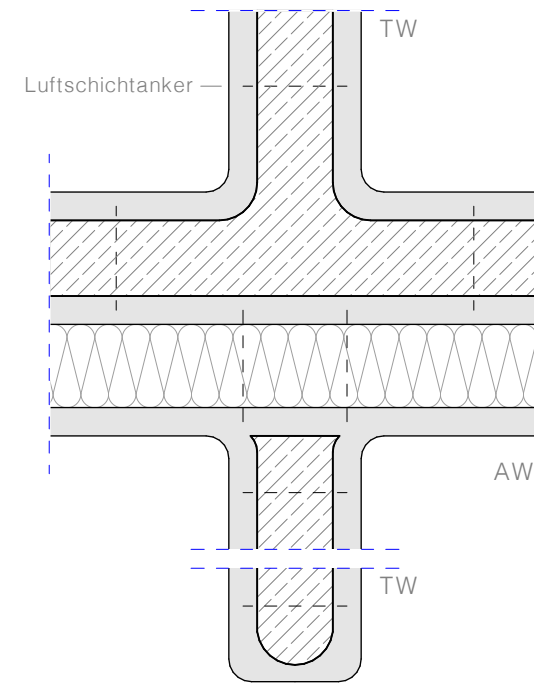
Detail Verortung Grundriss | M 1.500
